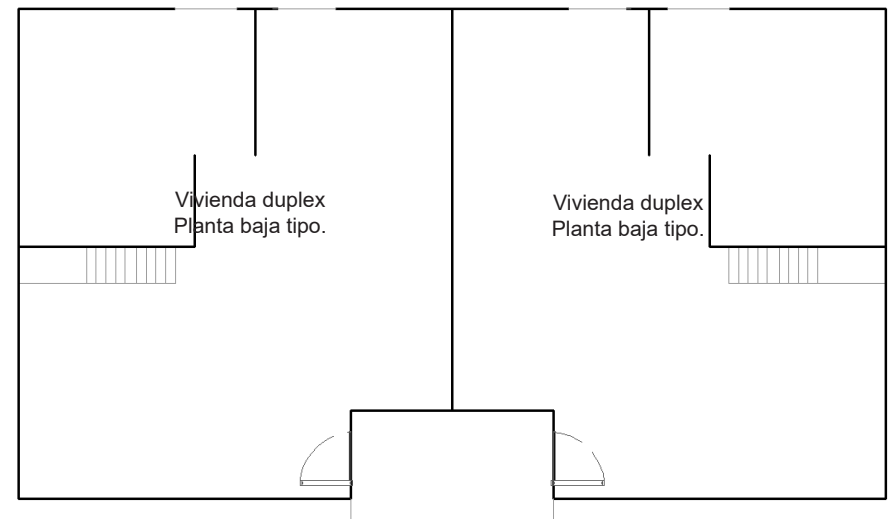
Planta baja tipo vivienda Dúplex. Elaboración propia (2022)
